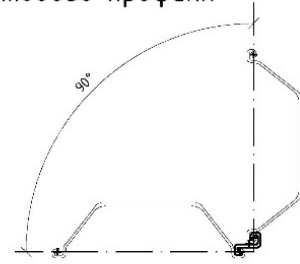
Конструкция шпунтов каркаса дамбы.
